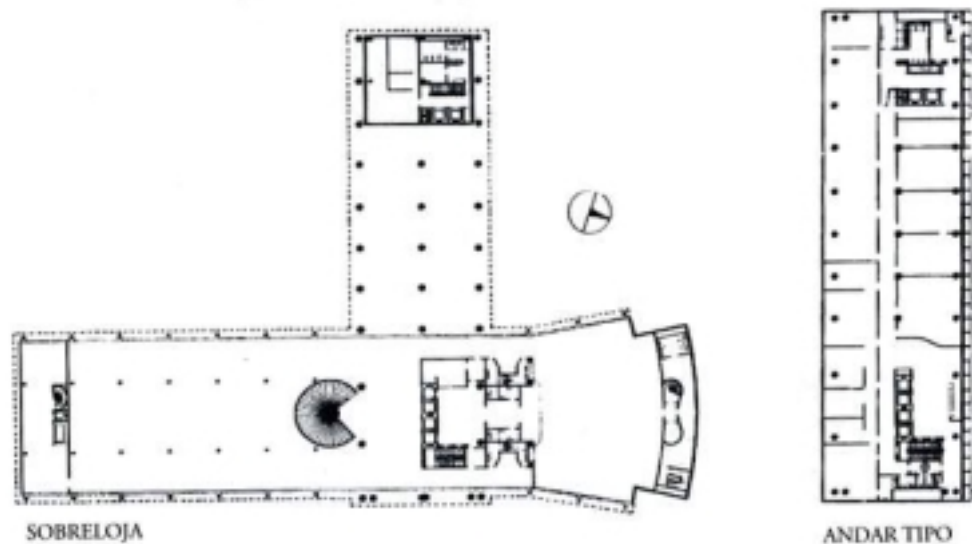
Ilustração da planta da sobreloja e do pavimento tipo do MEC. (Fonte: Costa, 1995).
